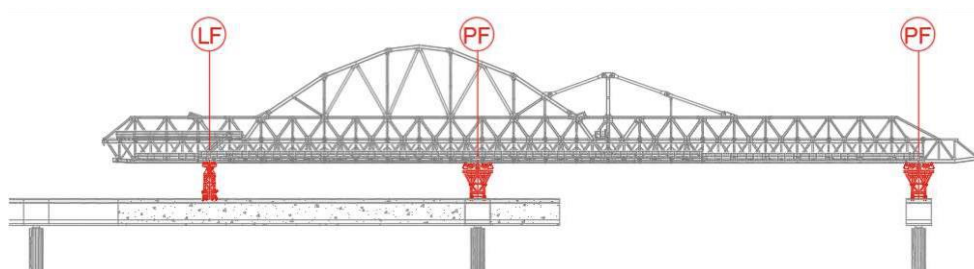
Pórticos de apoio de lançamento (LF) e do pilar (PF).
